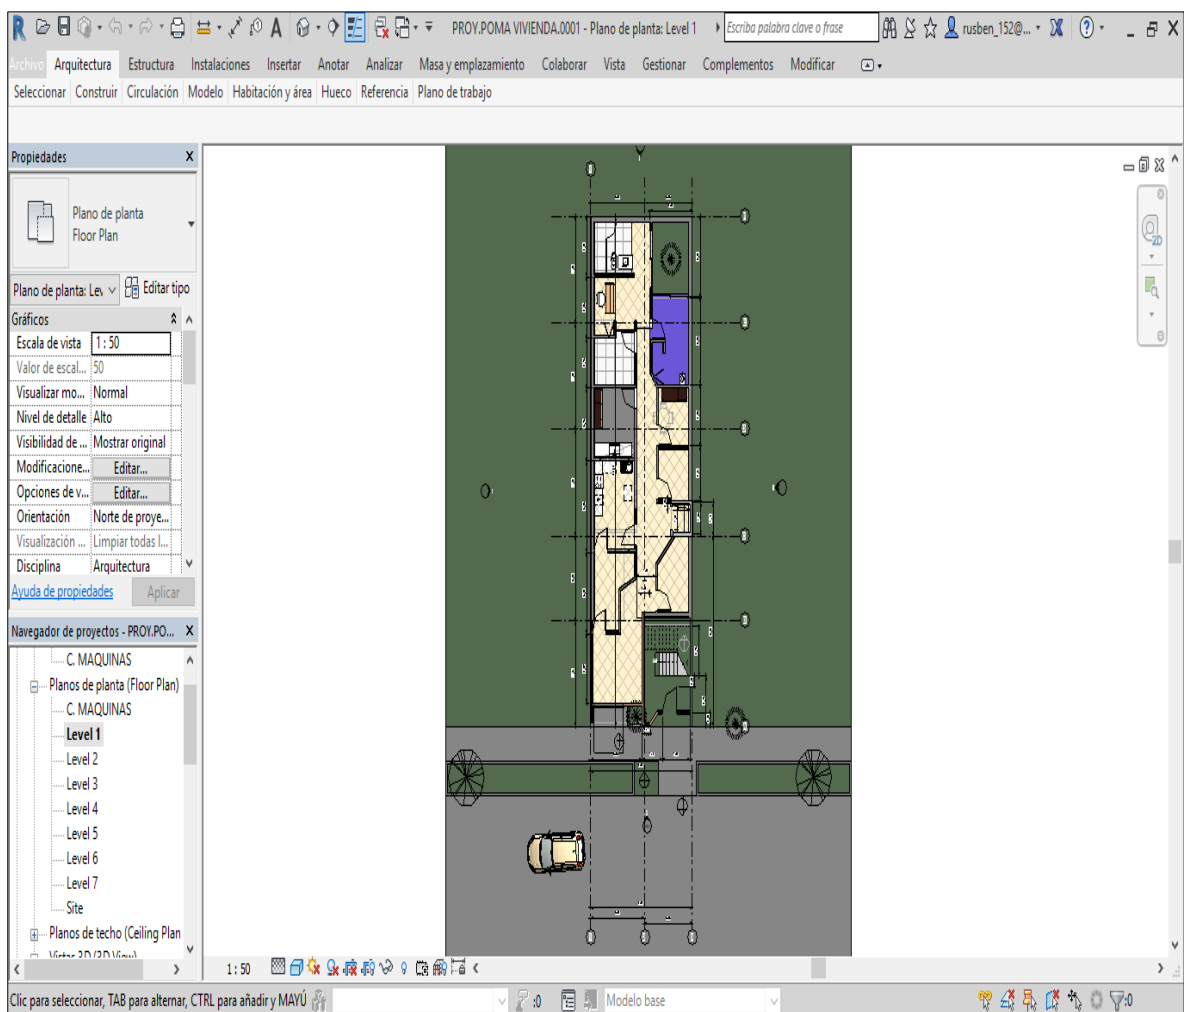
Plano en planta del primer nivel del modelo arquitectónico en la plataforma Revit -2018.
